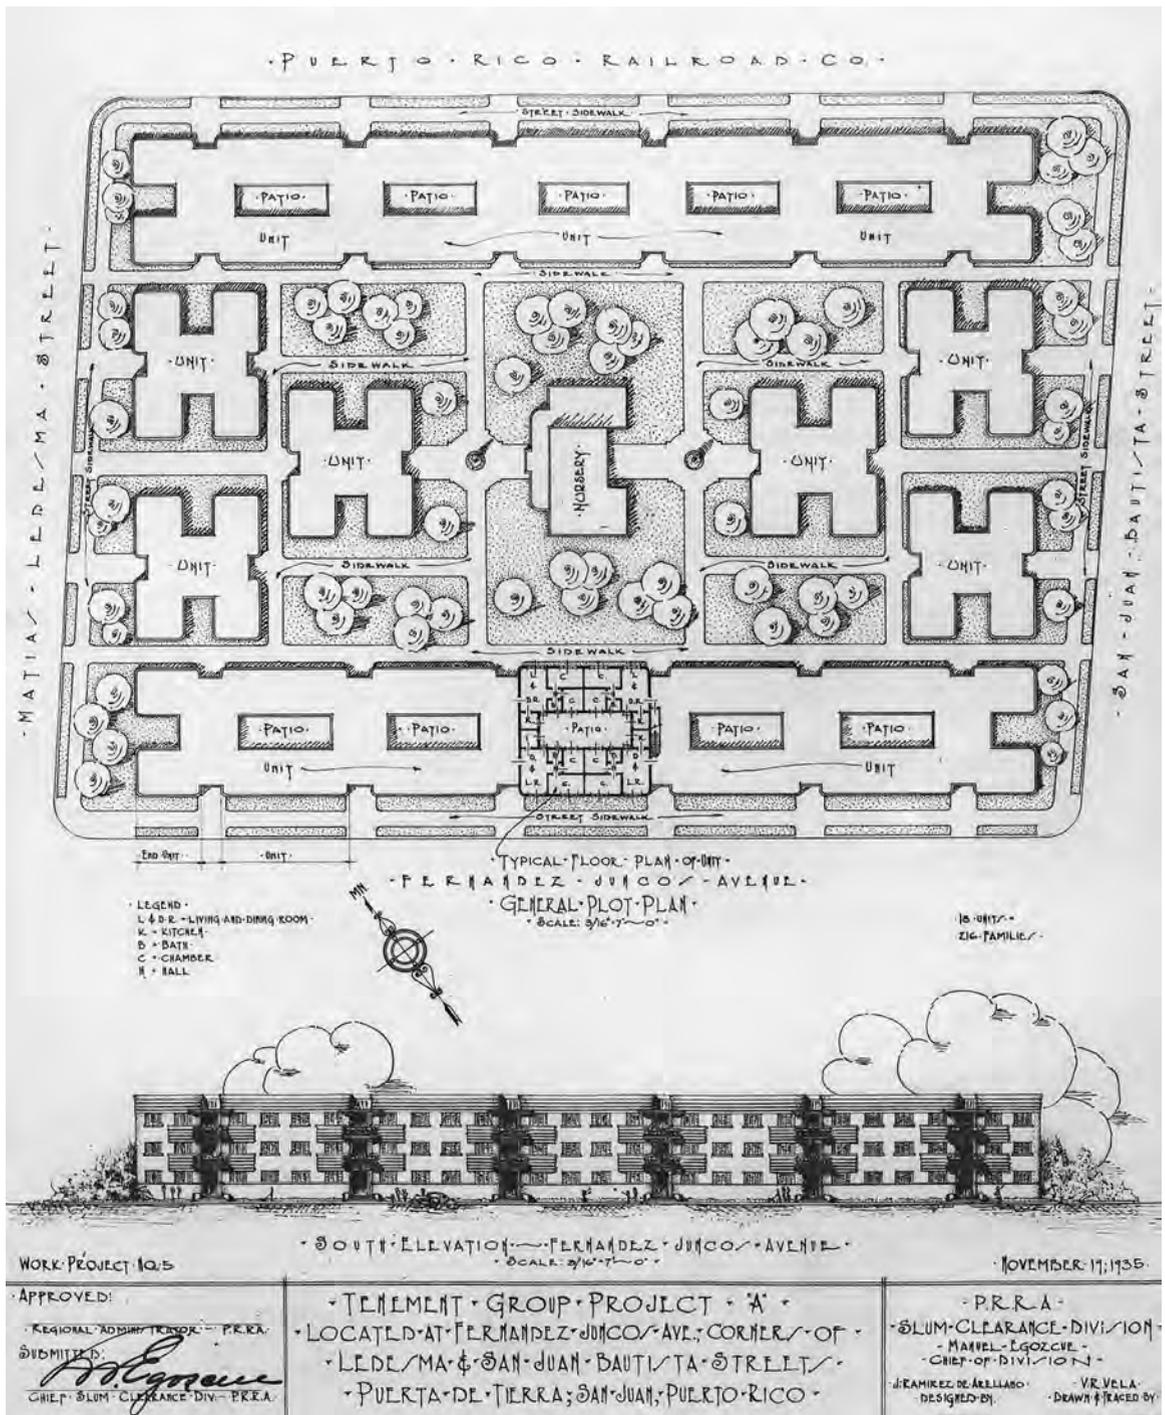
Plano de situación y alzado principal, El Falansterio, "Tenement Group A", Jorge Ramírez de Arellano, arquitecto, 1935. AACUPR. Colección El Falansterio.
